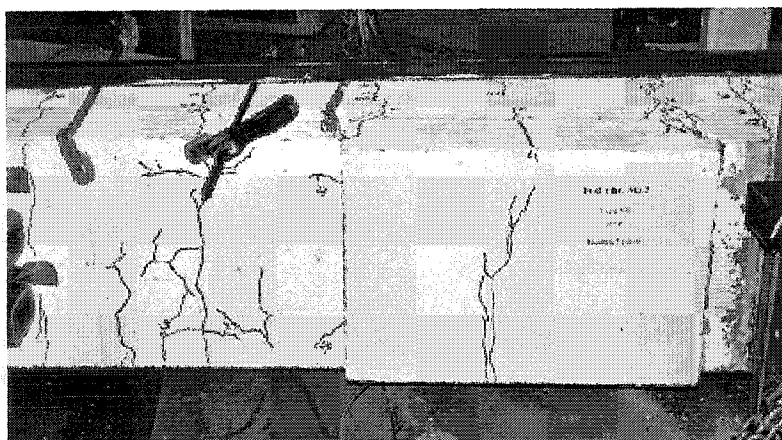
Patron de fissuration du spécimen F2
